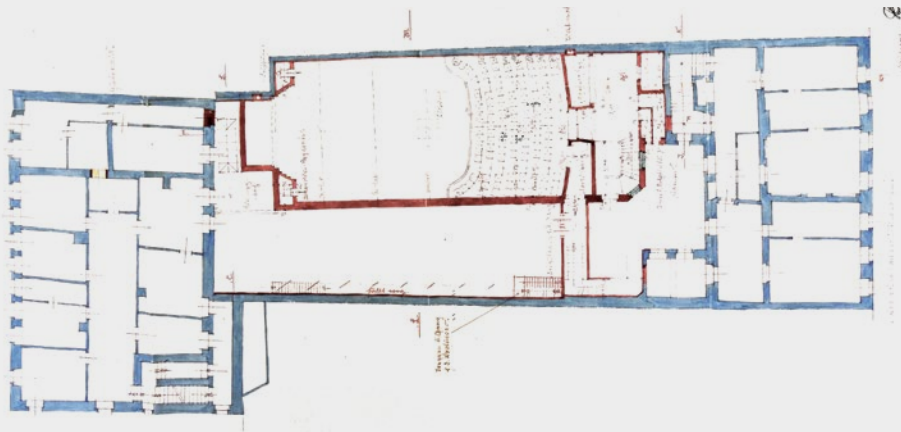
Geplanter Abriss und Errichtung eines Lichtspielhauses im Jahr 1928
